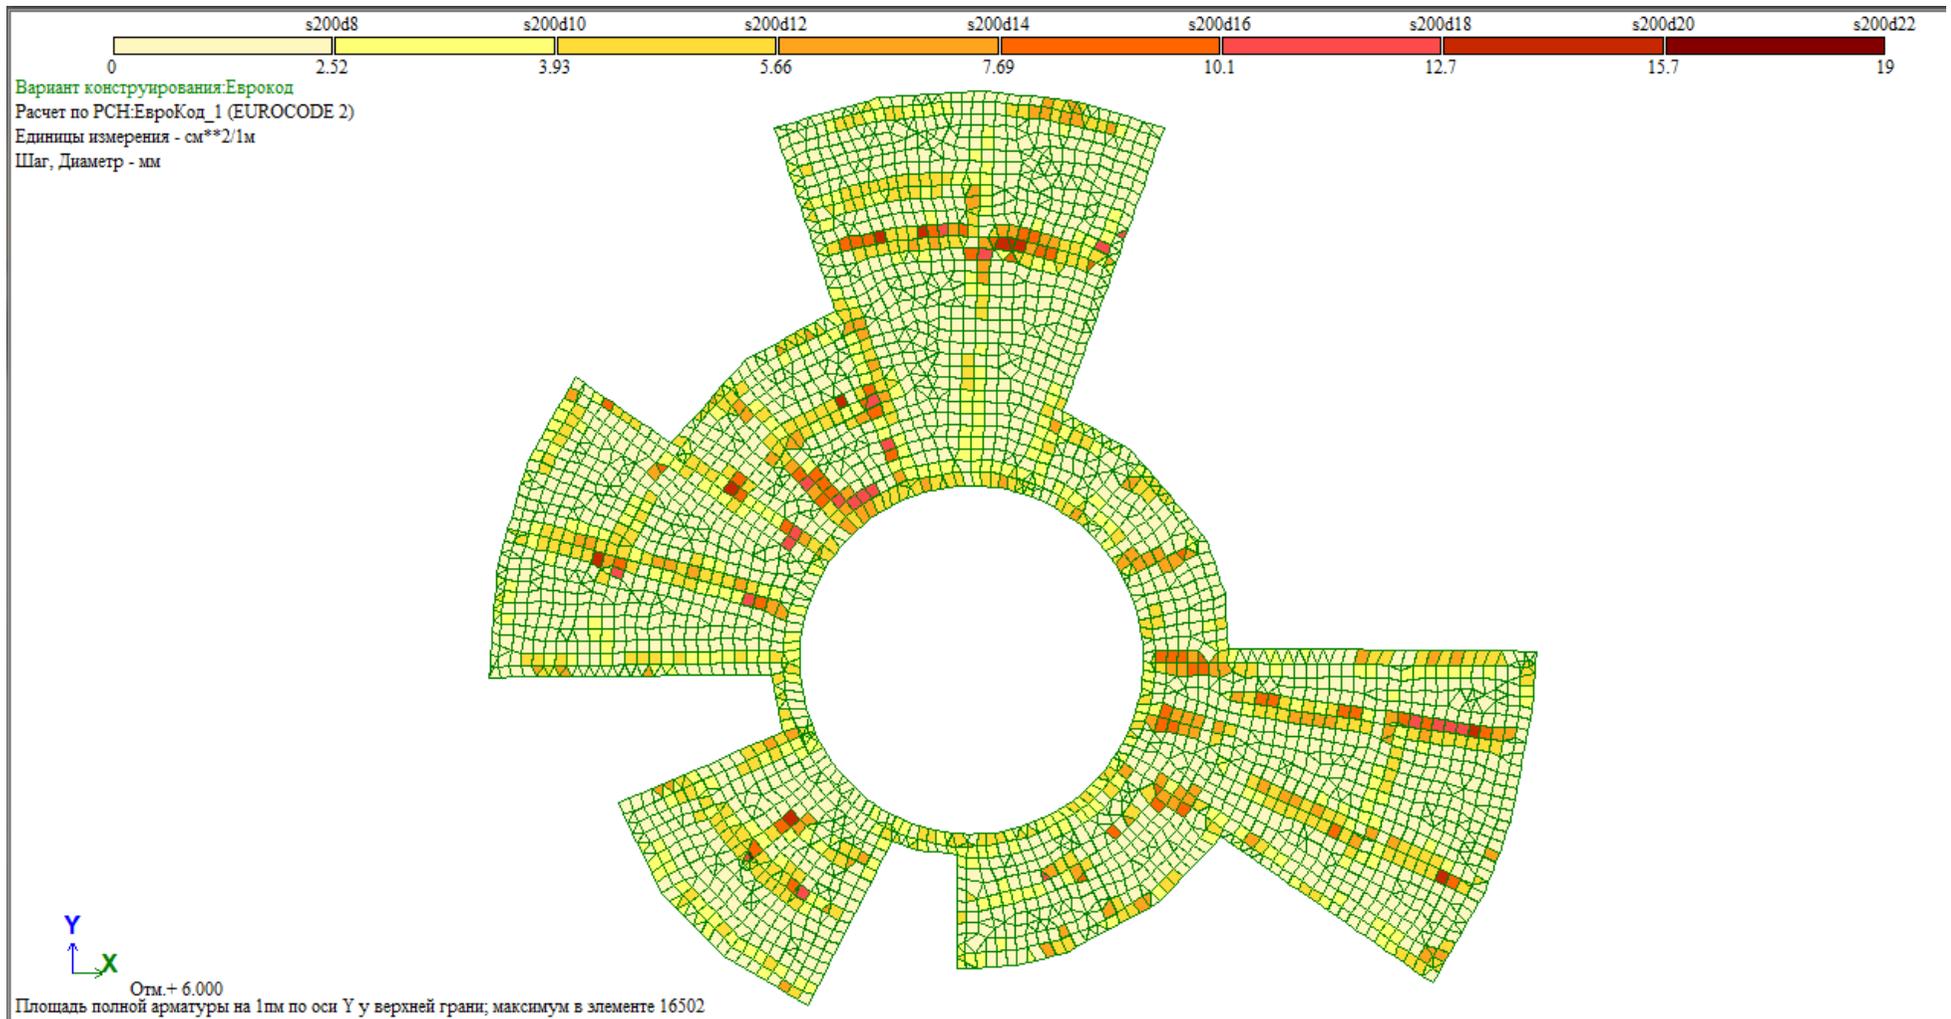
Плита. Площадь полной арматуры на 1 мм по оси Y у верхней грани
